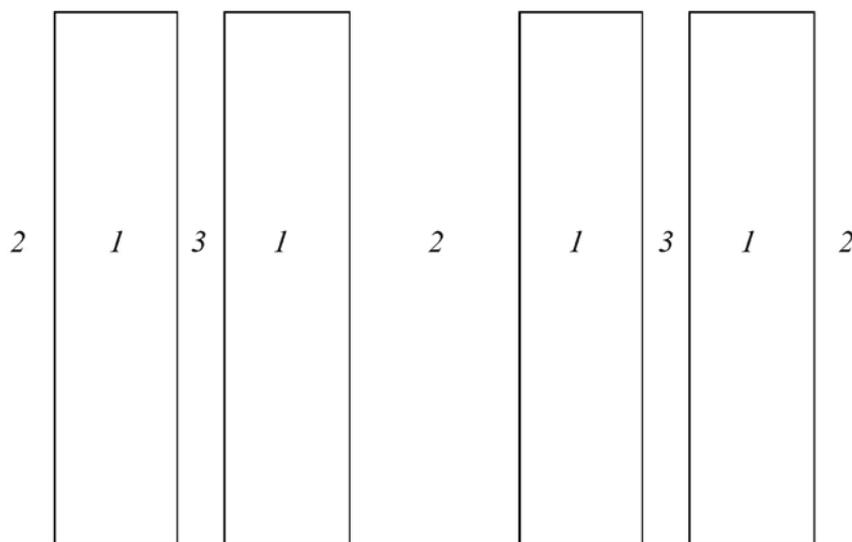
Схема склада круглого леса (влажного способа хранения): 1 — квартал штабеля; 2 — площадка для разворота ПА; 3 — пожарные проезды
